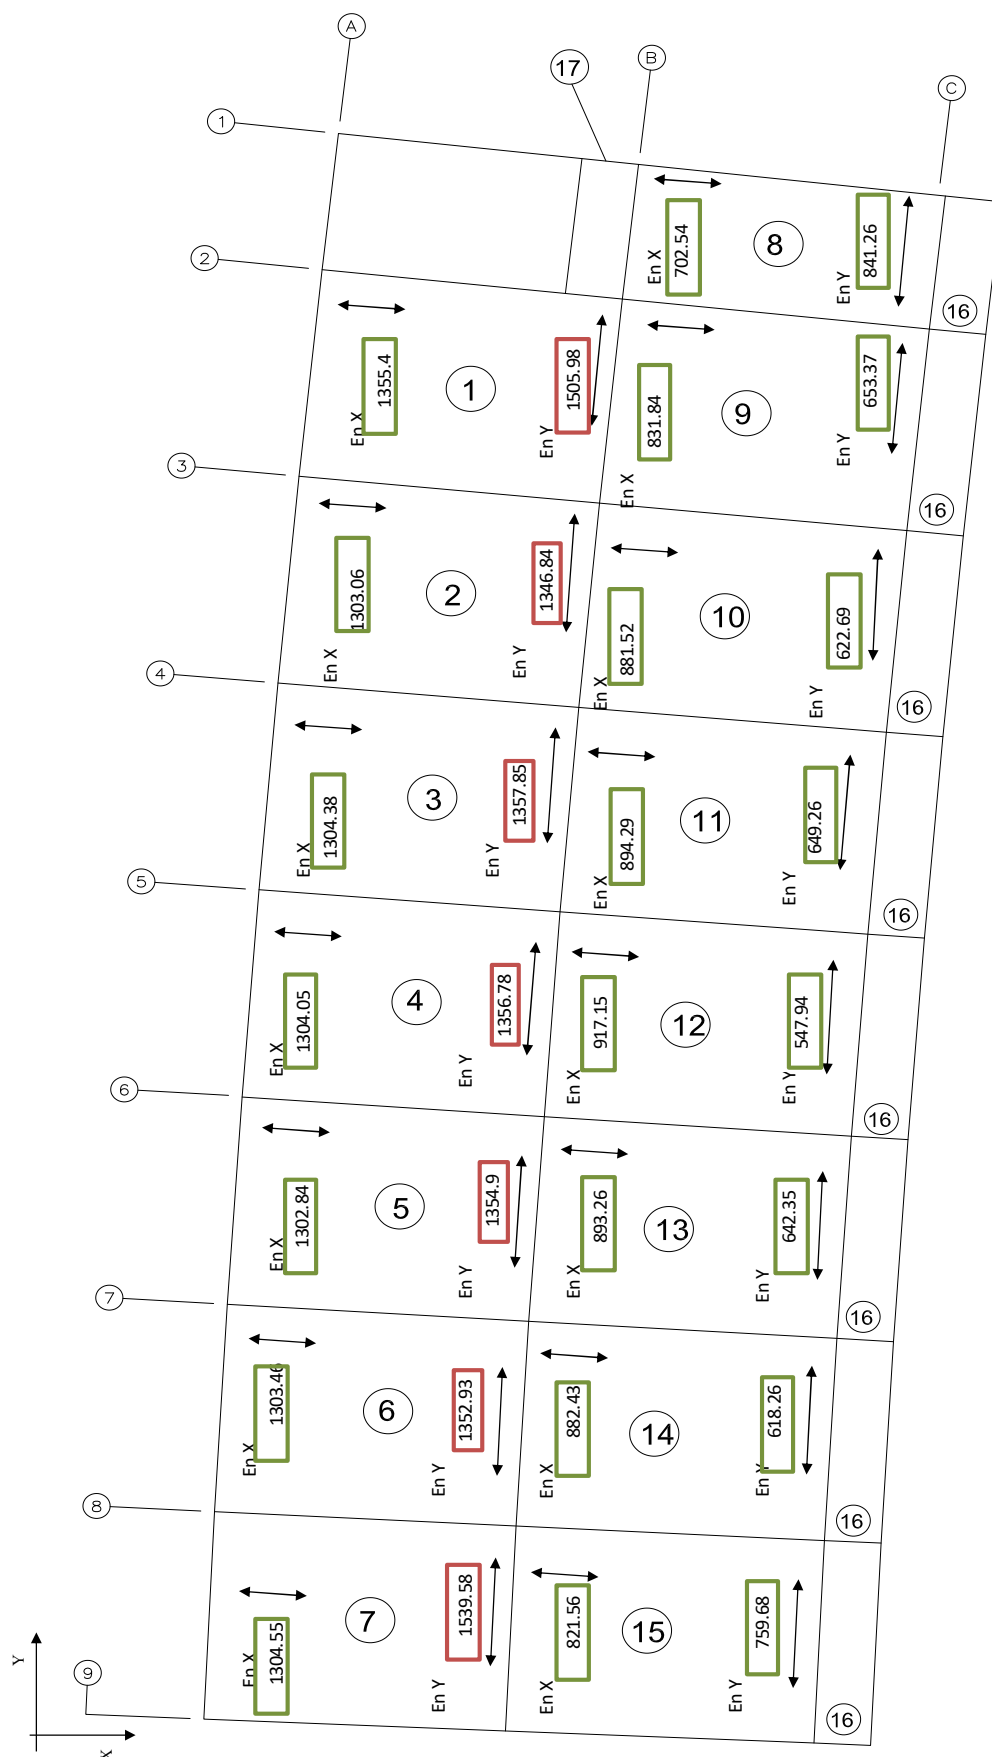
Distribución de acero necesario en el interior de la losa – BLOQUE A
